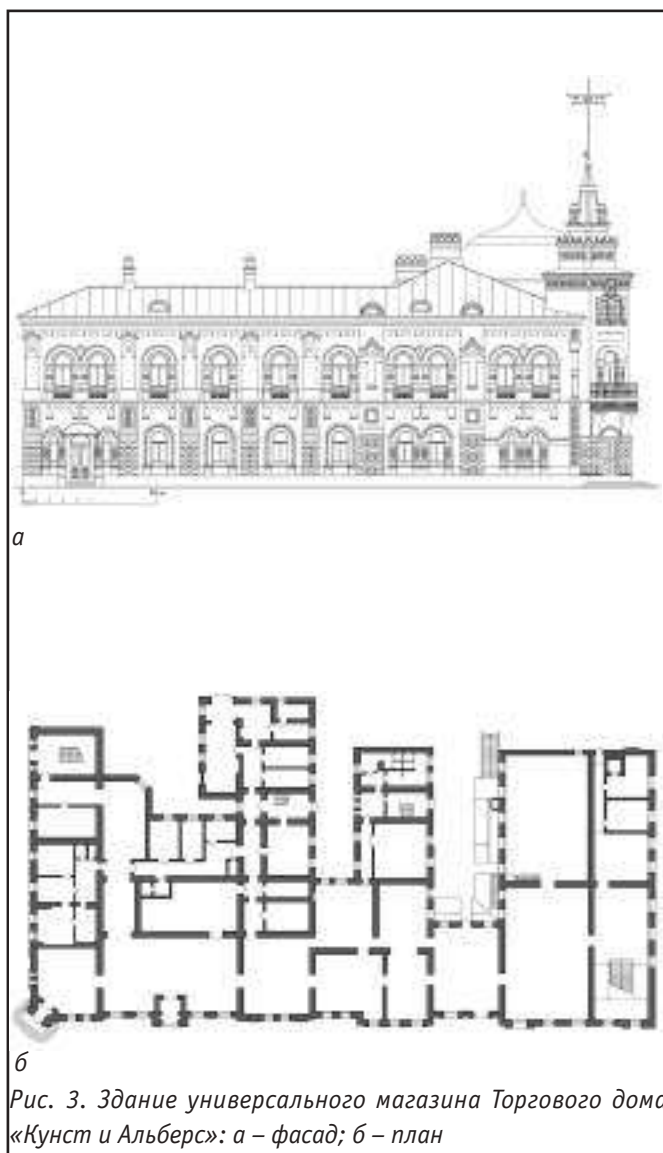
Здание универсального магазина Торгового дома «Кунст и Альберс»: а – фасад; б – план
